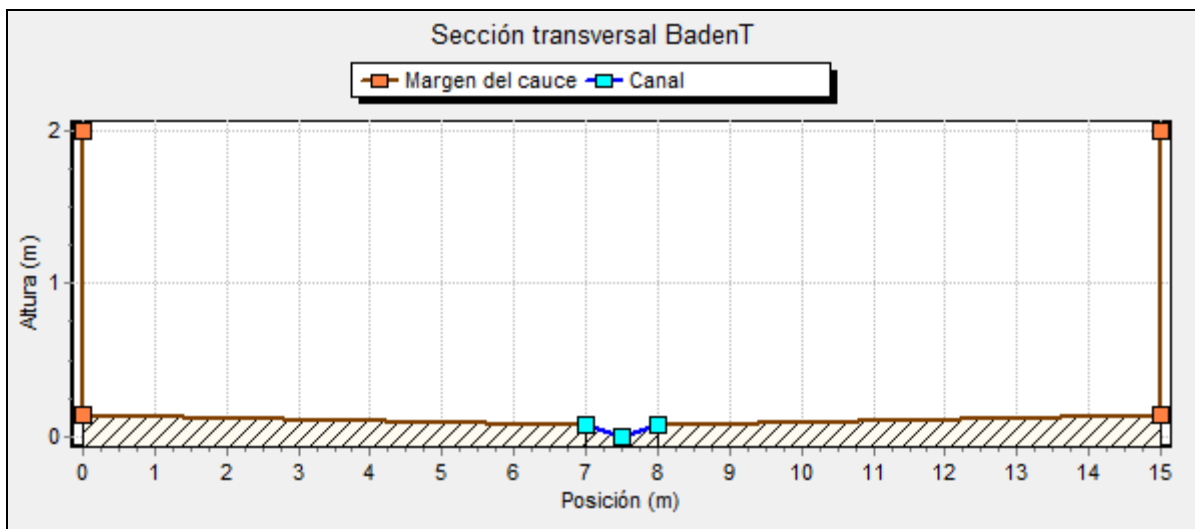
Sección transversal de badenes de tierra en calzada.
